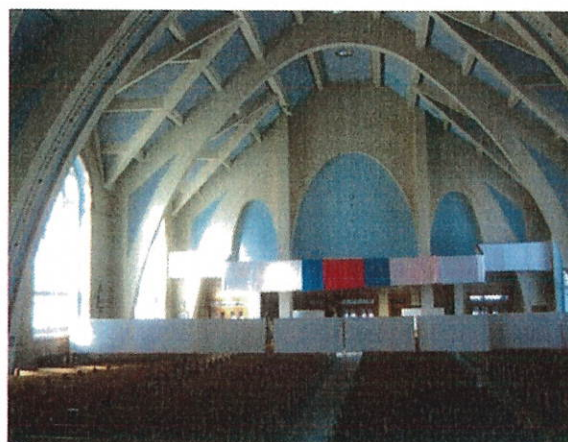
Arche de l'entrée – Fissure sur la périphérie – Janvier 2013
